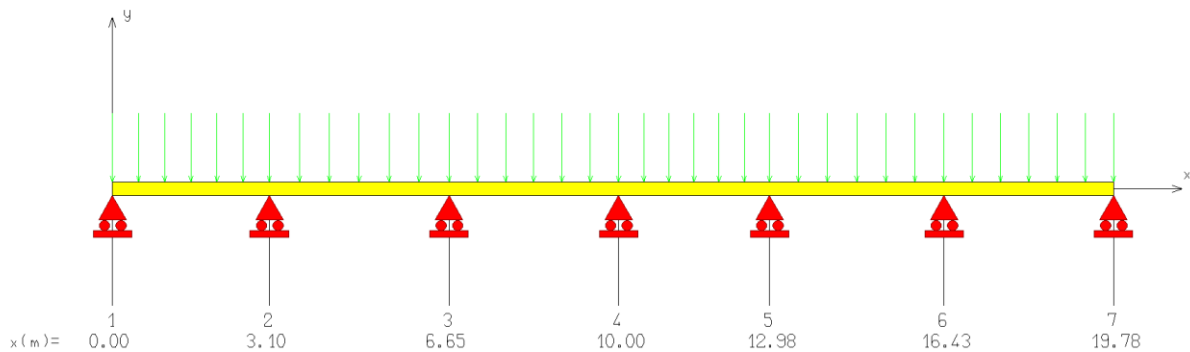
Schéma statique de la poutrelle la plus défavorable.
